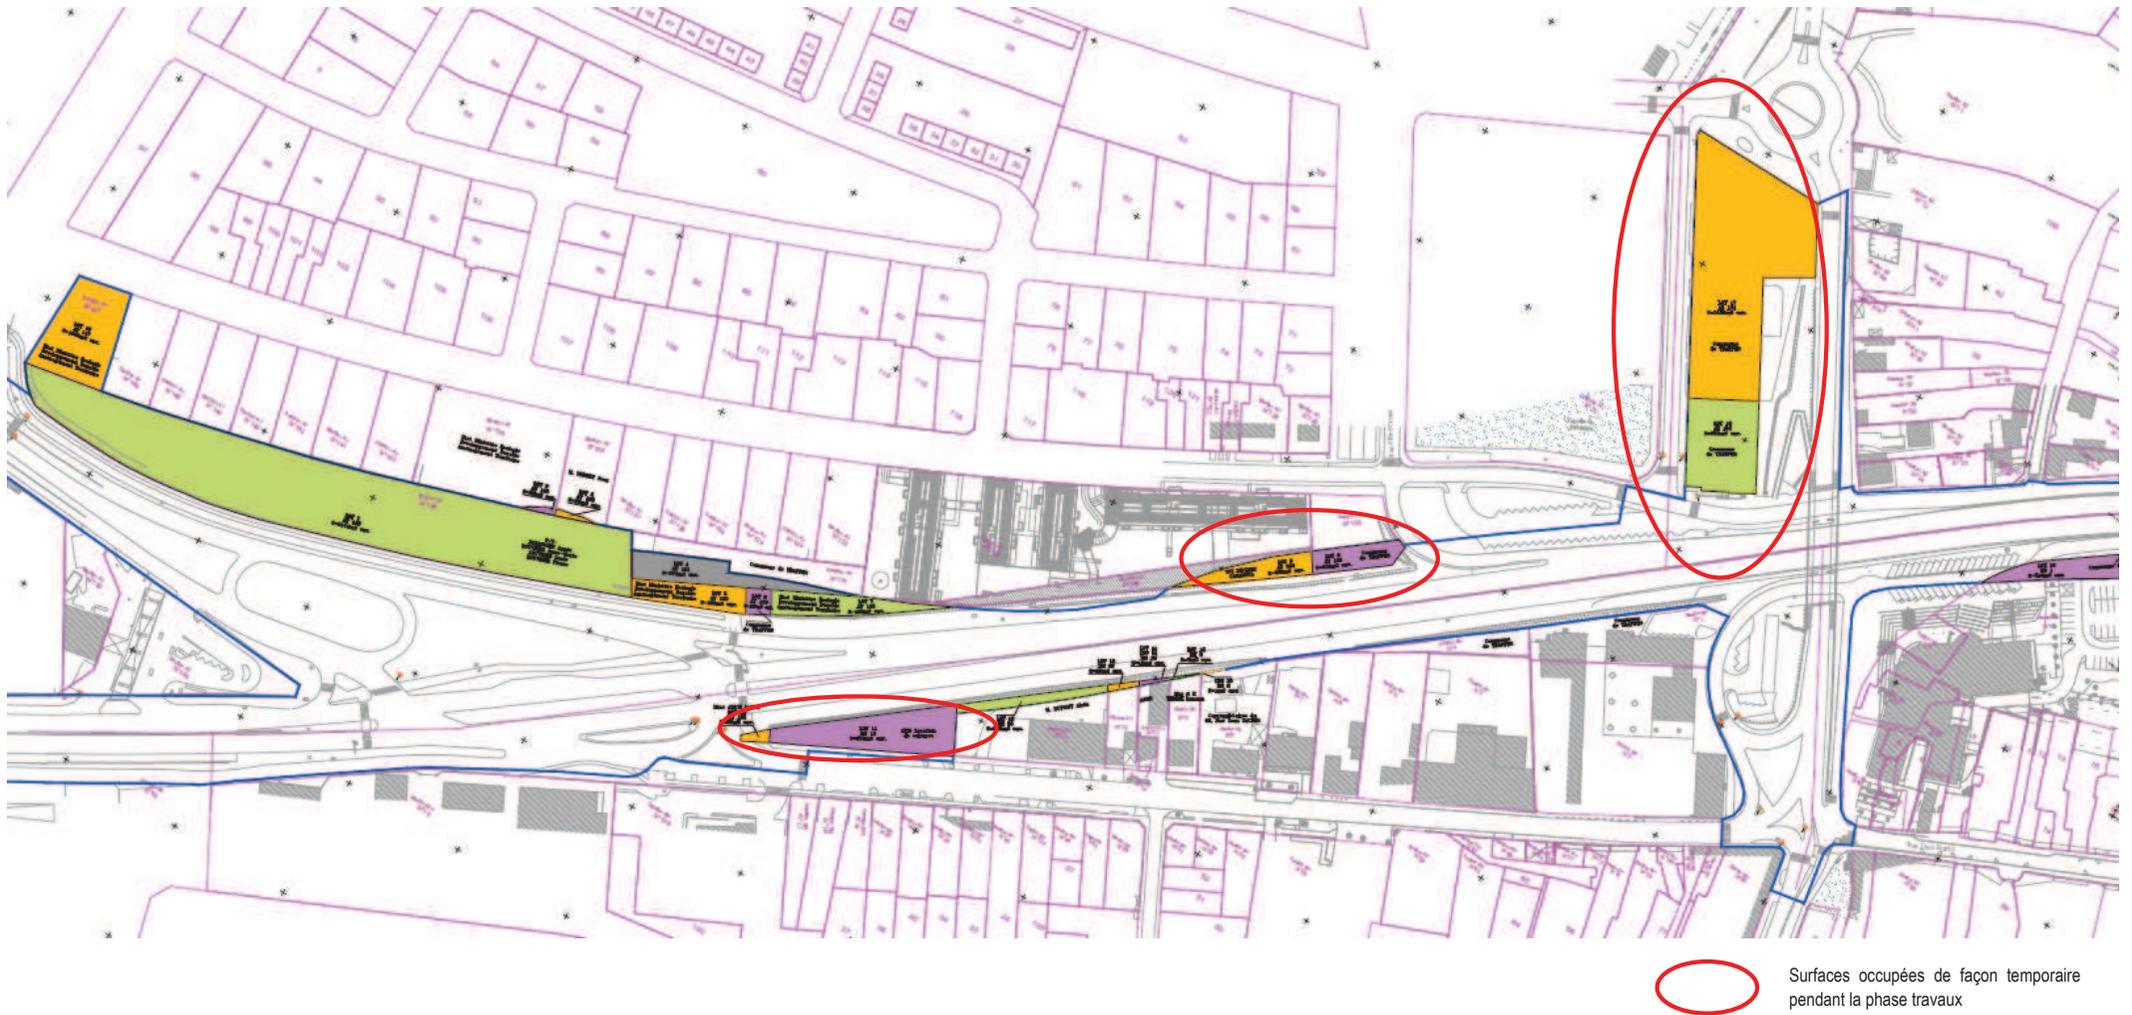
Impact foncier en phase travaux sur la section Ouest du projet (source : Plans parcellaires géométrique, juin 2015)
